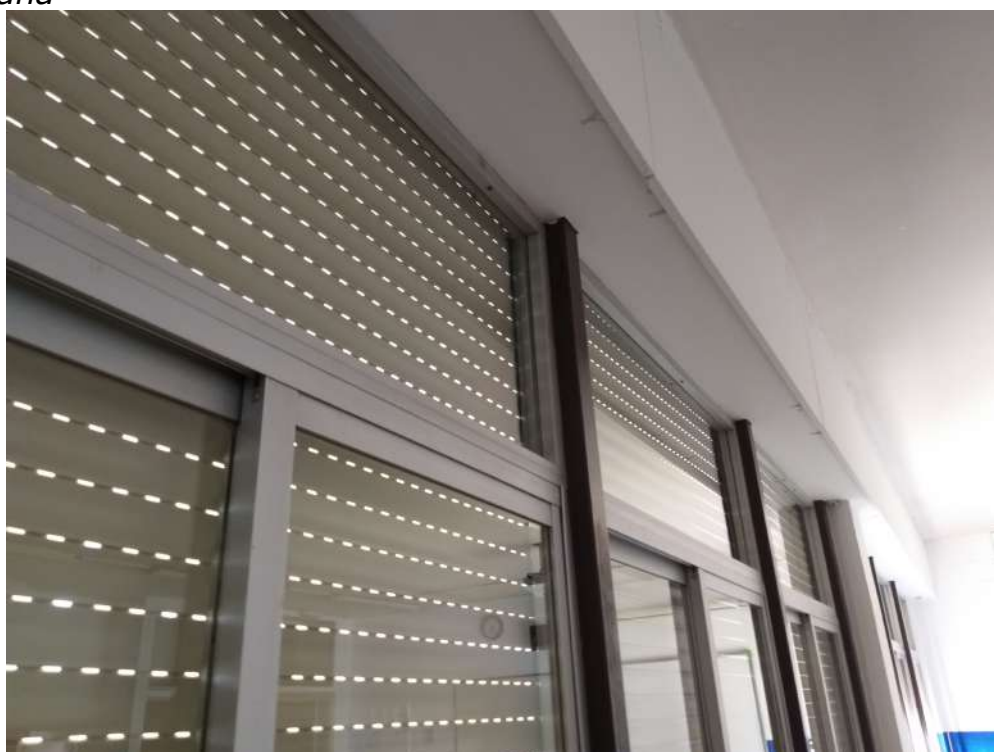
Detalle carpintería y perfiles metálicos ventanales.
